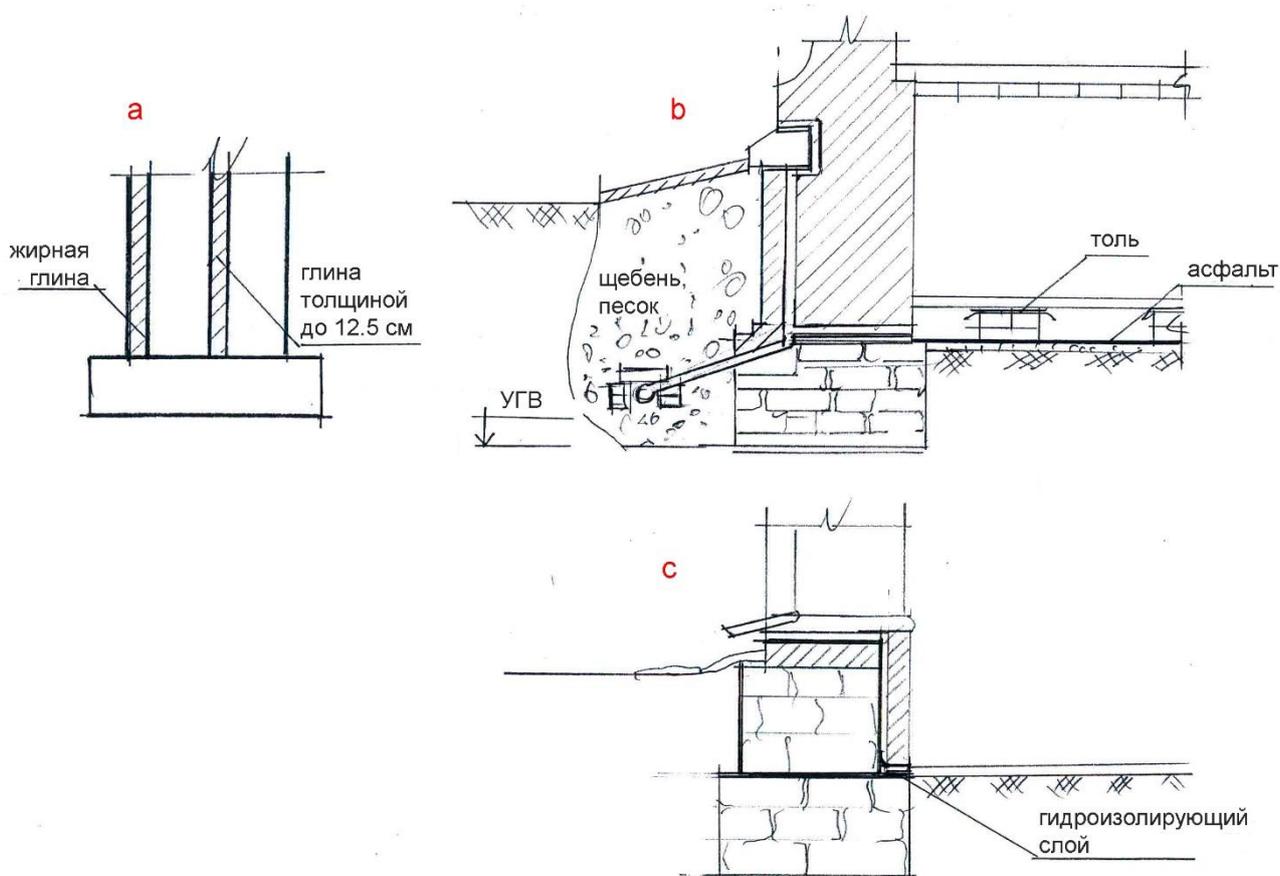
Устройство двуслойных фундаментов при большой влажности грунтов: а – фундамент с глиняной прослойкой и глиняным замком; б – фундамент с воздушной прослойкой у наружной грани стены; с – фундамент с воздушной прослойкой у внутренней грани стены
